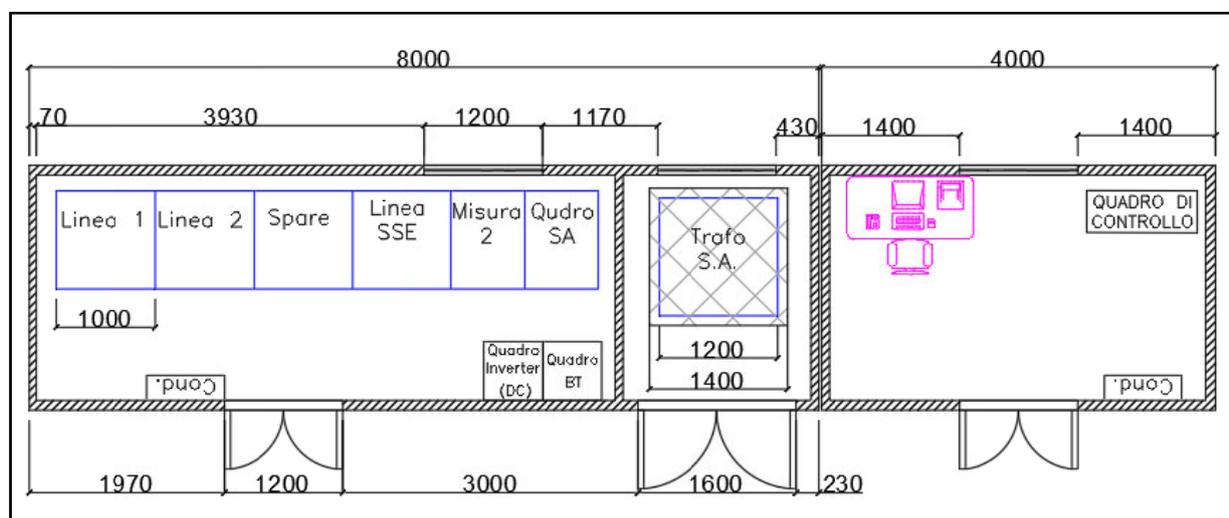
Planimetria elettromeccanica cabina di raccolta- Elaborato H.04
